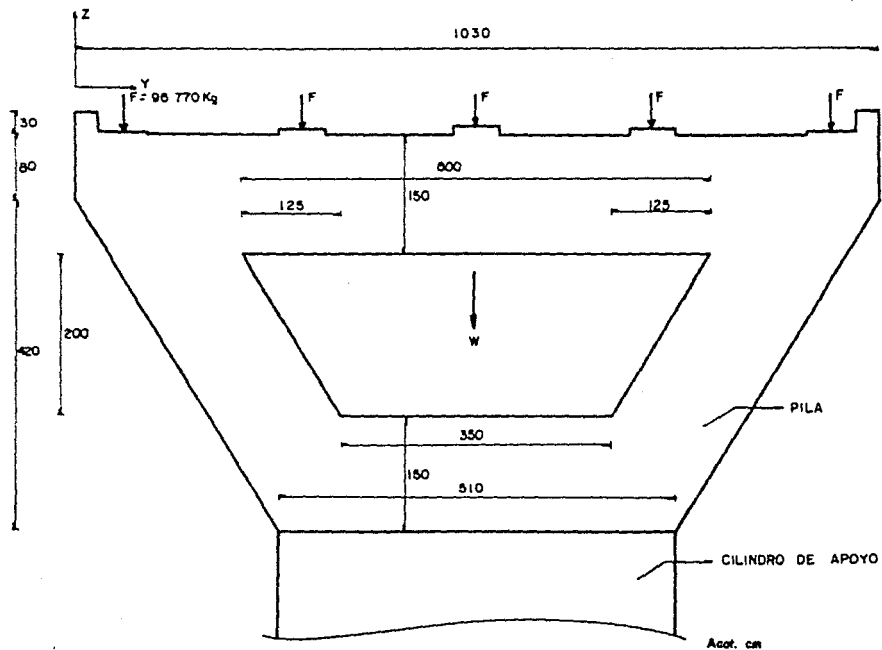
Pila número 2.- Dimensiones, sistema de cargas y de apoyo, donde la planta de la pila es la misma que la de la pila número 1.
